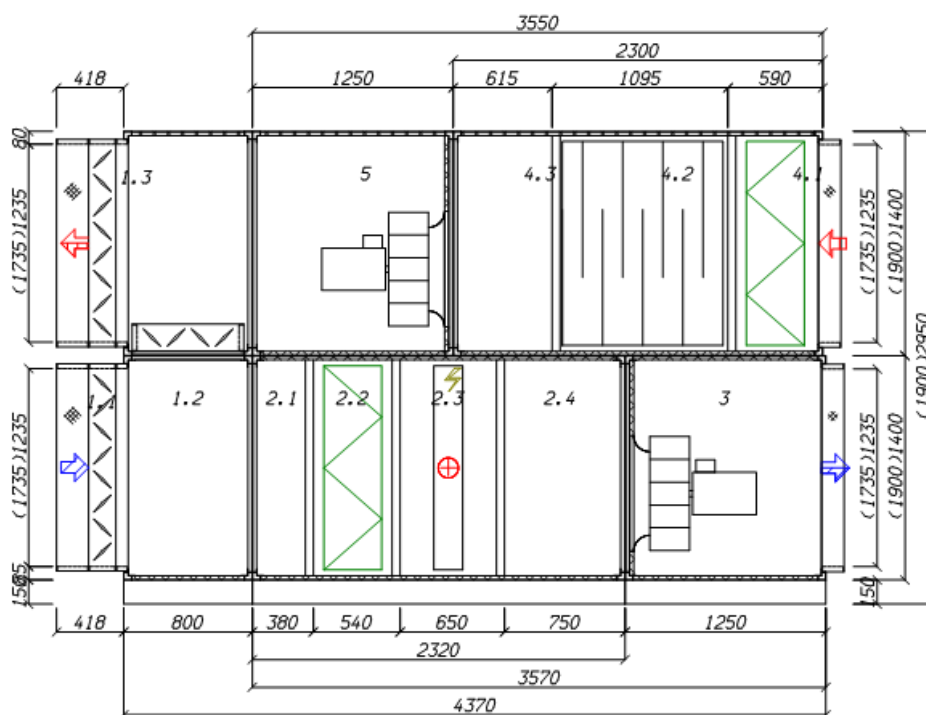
Схема отопительной вентиляционной установки:
